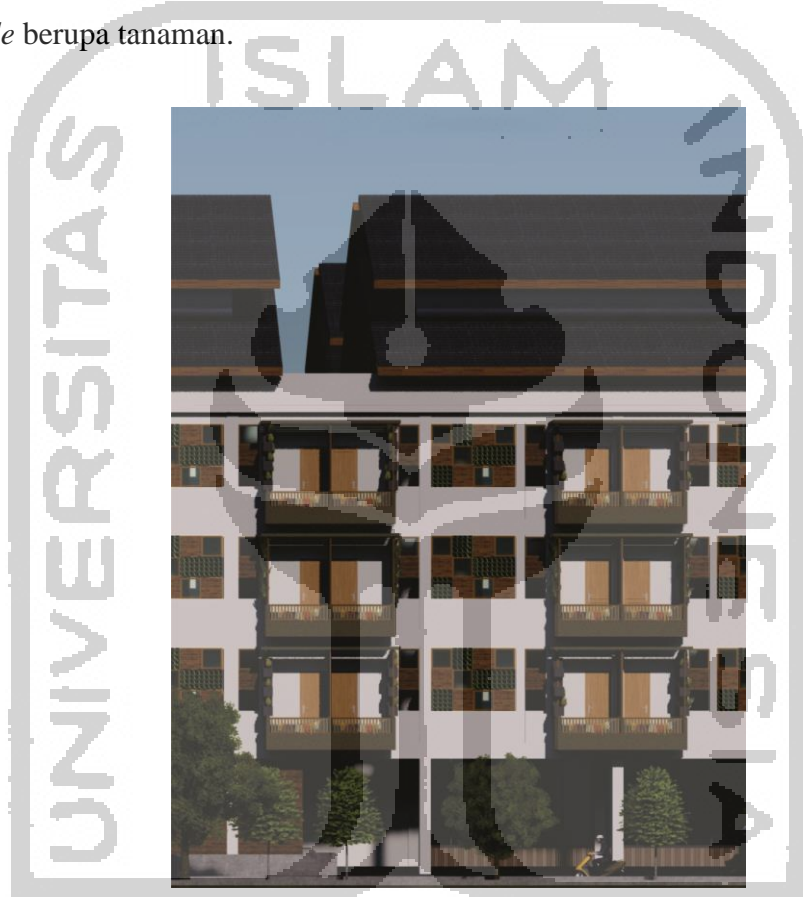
7 Penerapan Green Façade pada Bukaan
